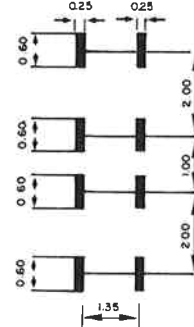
Système de calcul de surcharge des ponts (Biblio 26)
